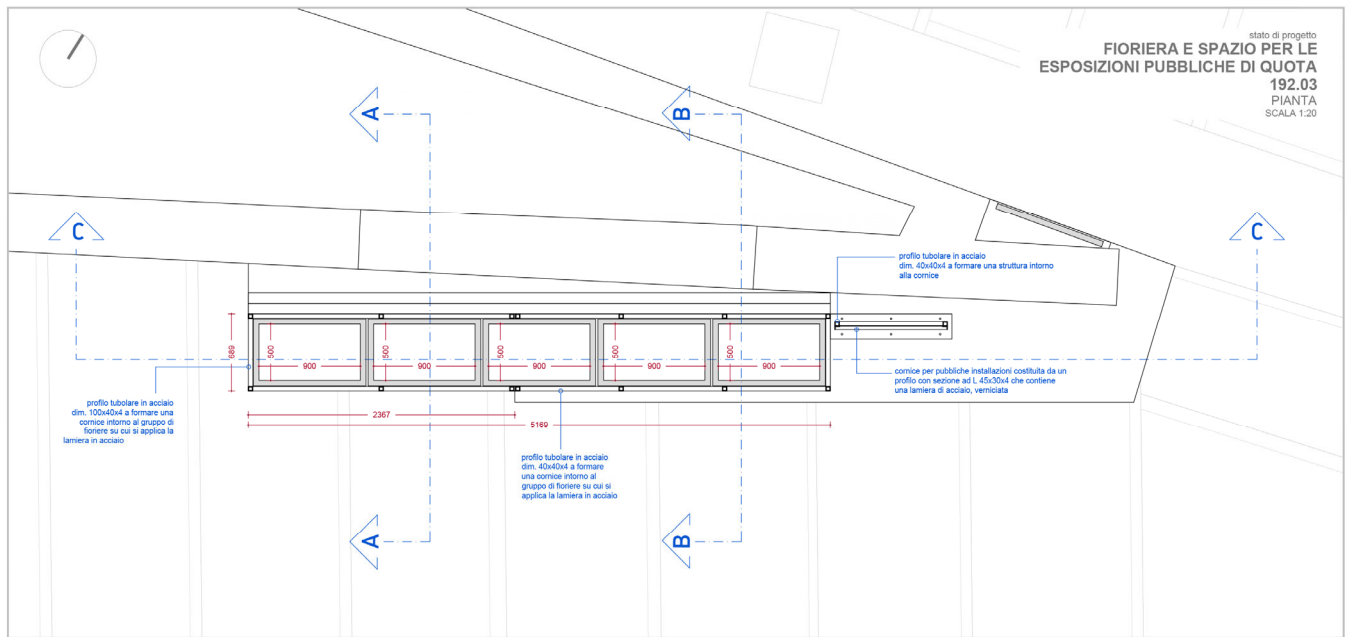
Progetto – pianta degli inserti in finitura “canna di fucile”
